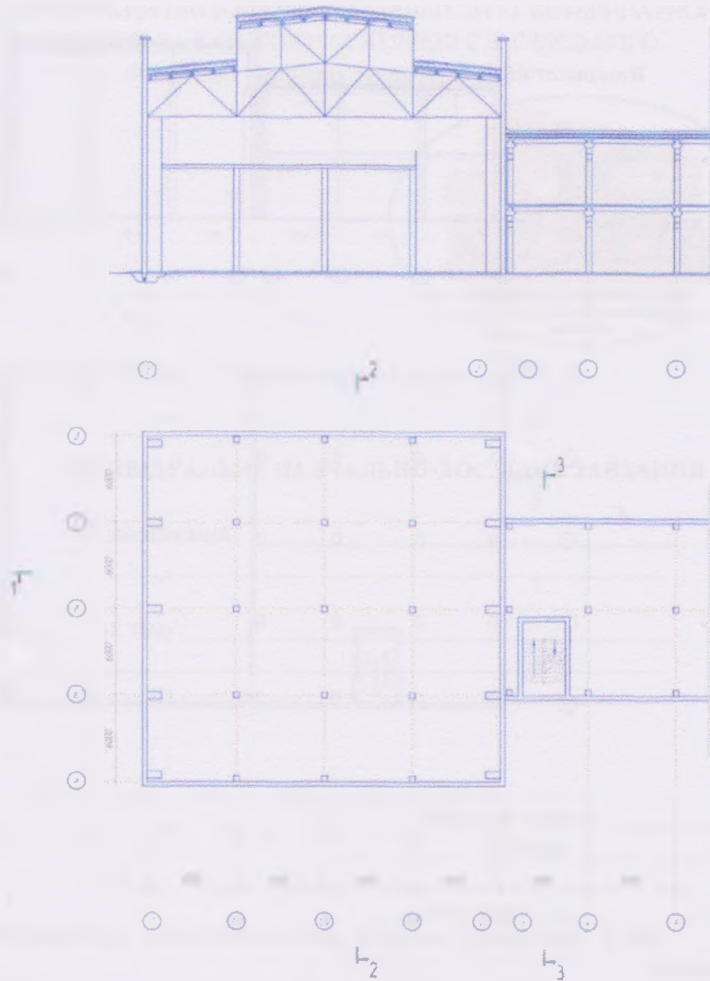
Схема плану та розрізу промислової будівлі до завдання контрольної роботи.
